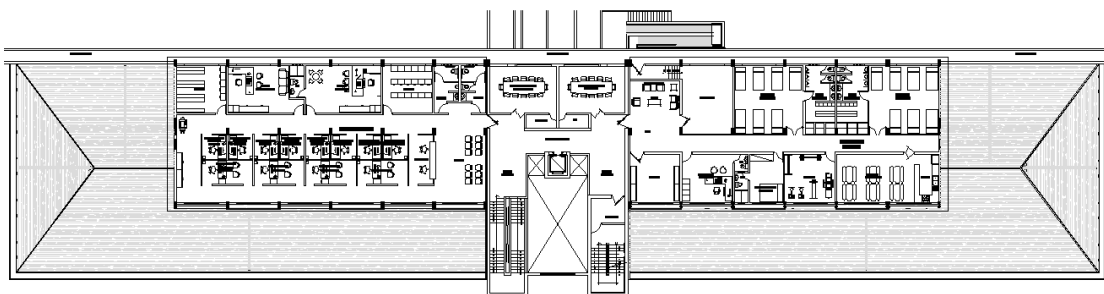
Primera planta del edificio de control de la zona E
